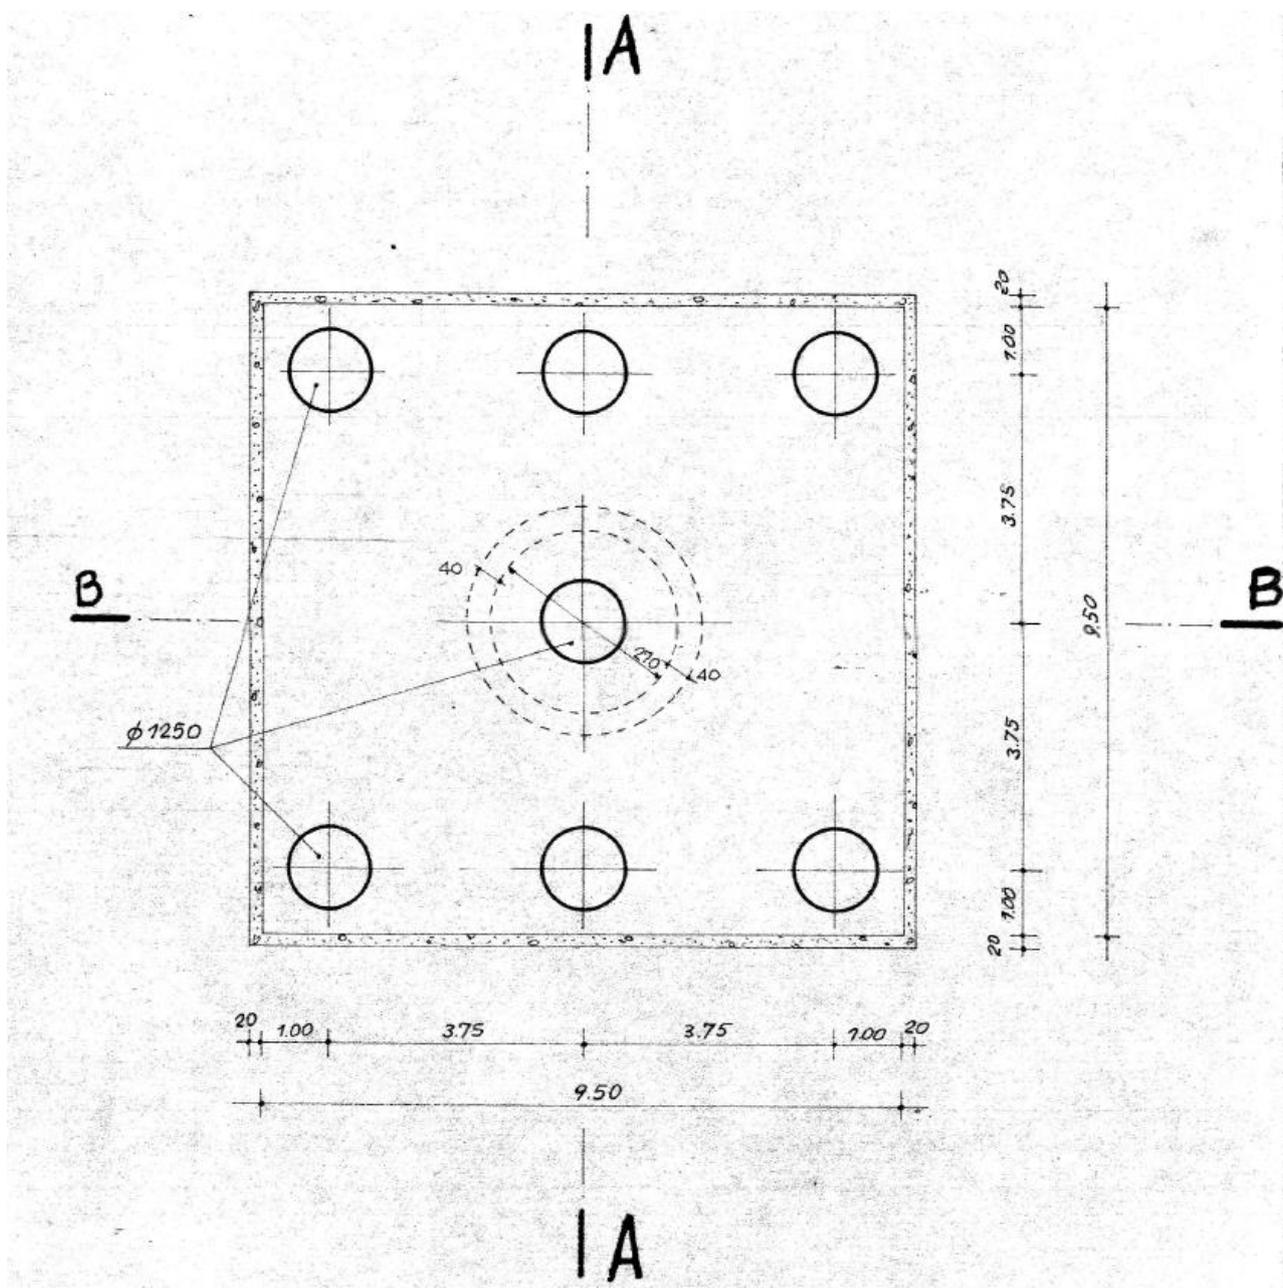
Impalcato a 3 travi in CAP – Pianta plinti ad 7 pali
